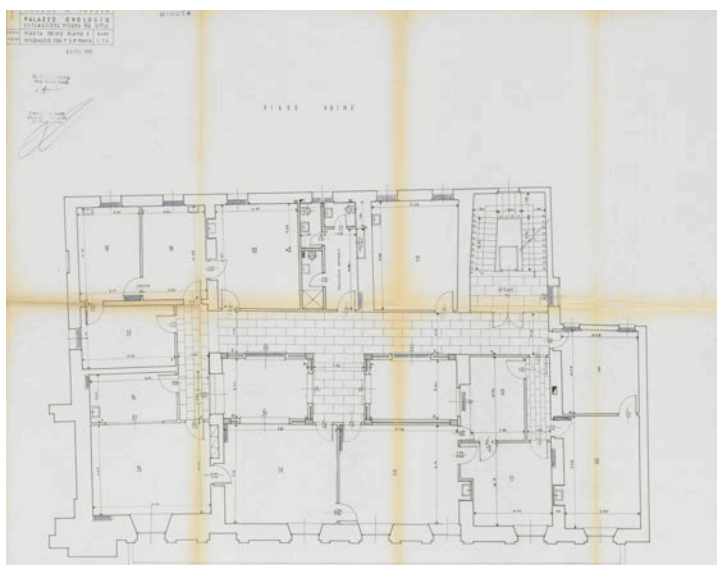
Estratto pianta piano primo (1960) - (Archivio del Comune di Padova)
